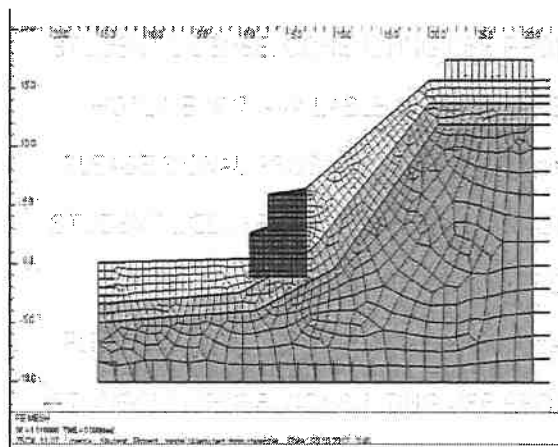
Założona konstrukcja geotechniczna w postaci muru oporowego projektowanego przy skarpach wokół inwestycji drogowych, który jest wykonany z gabionów wypełnionych odpadami górniczymi w postaci przebadanych i zaklasyfikowanych gruntów antropogenicznych.
